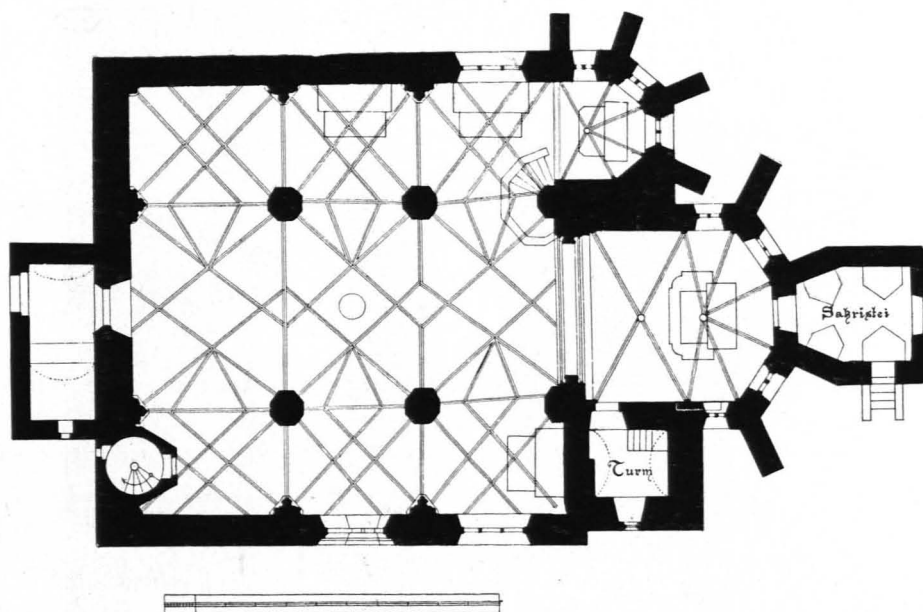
Mödring, Pfarrkirche, Grundriß 1:250 (S. 416)
